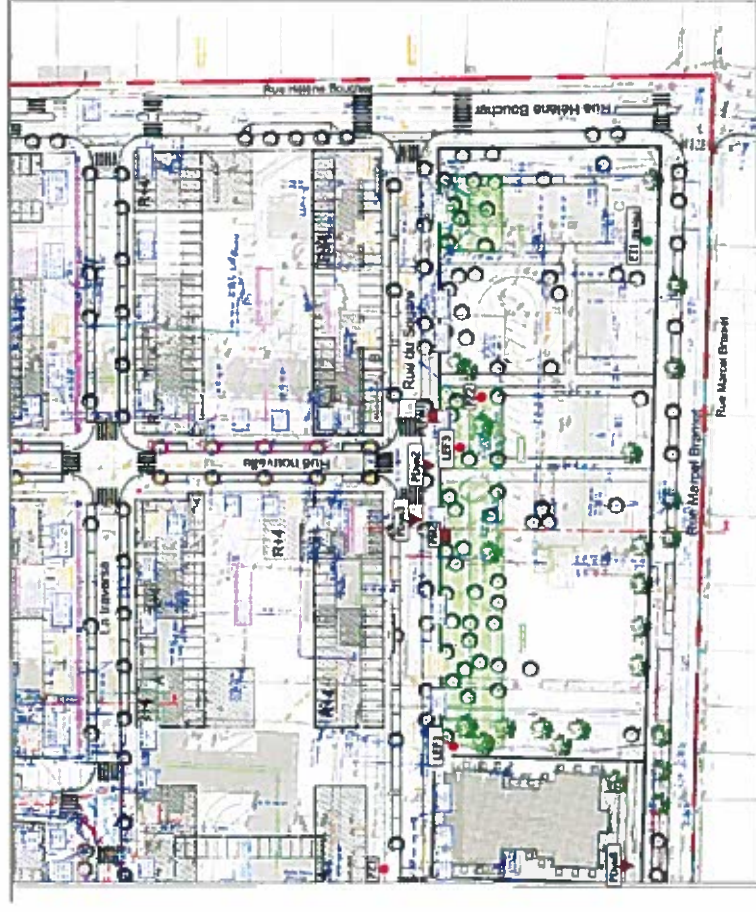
Plan d'implantation des sondages de l'étude FONDASOL d'avril 2017 - secteur Sud
